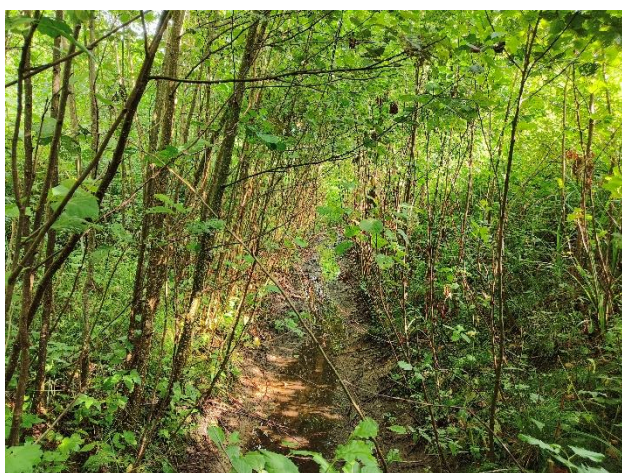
Funktsioneeriv kraav K-112 truubist T-3 allavoolu
